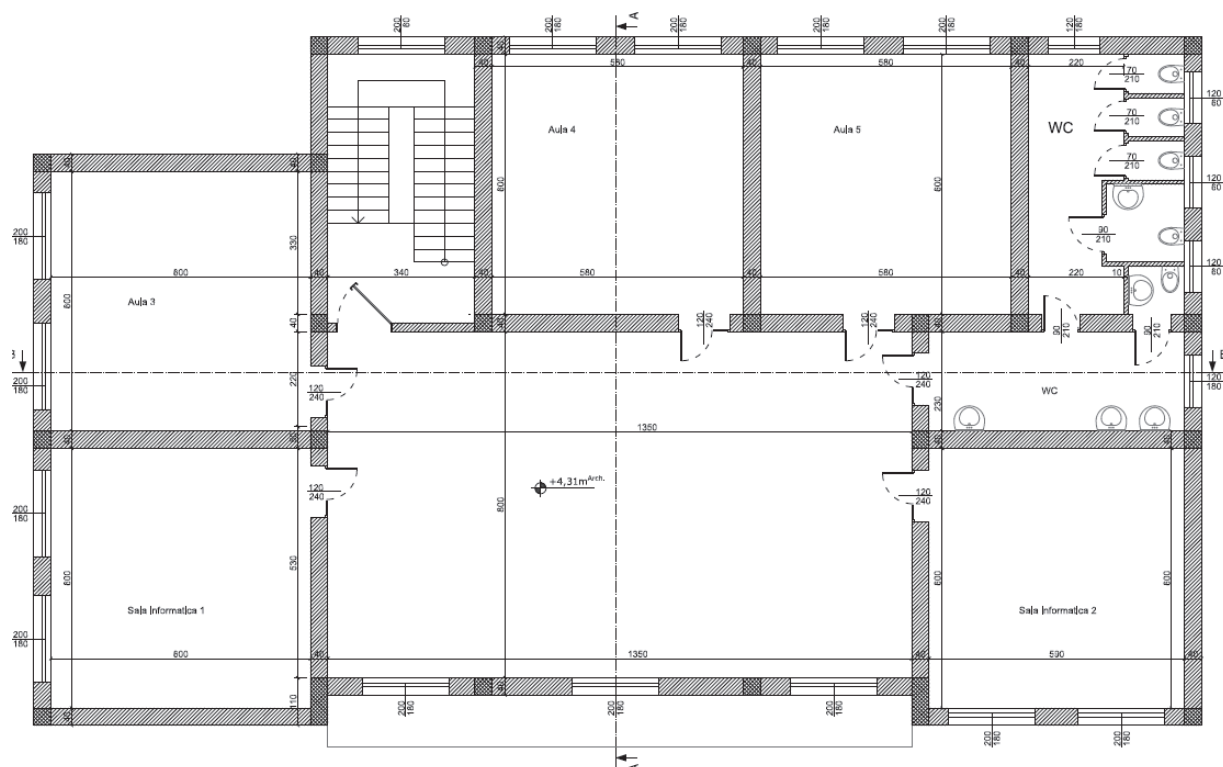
Pianta Piano Primo dell'Edificio
